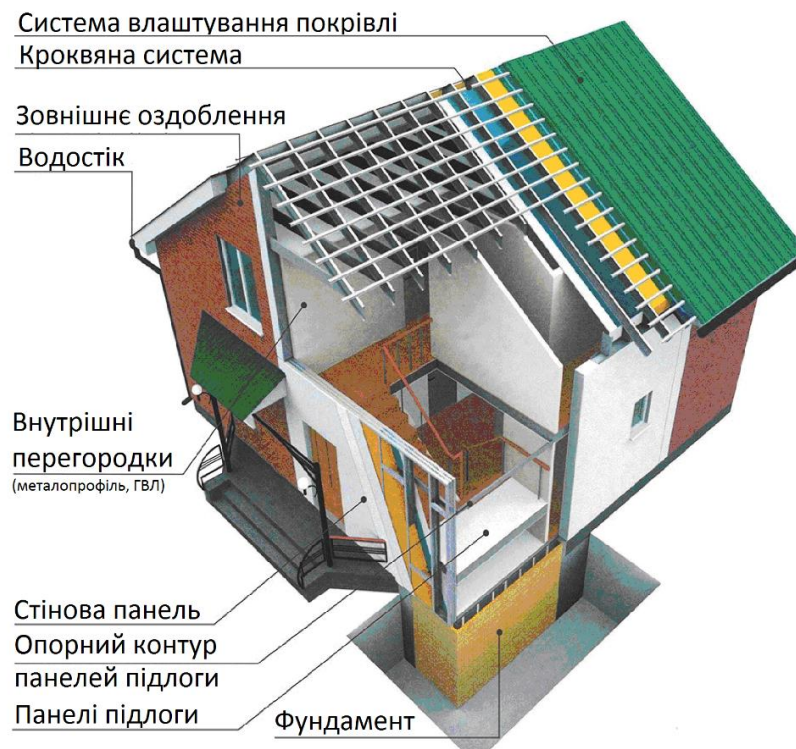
Принципова схема влаштування будівлі по технології Light Gauge Steel Framing
